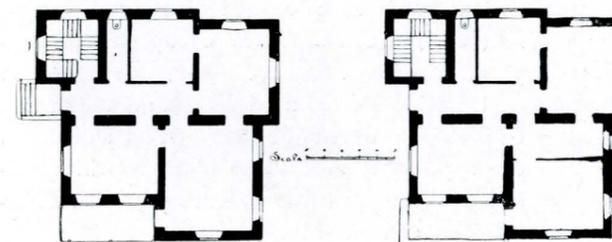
Pianta del piano terreno del villino del Direttore. Pianta del primo piano del villino del Direttore.
